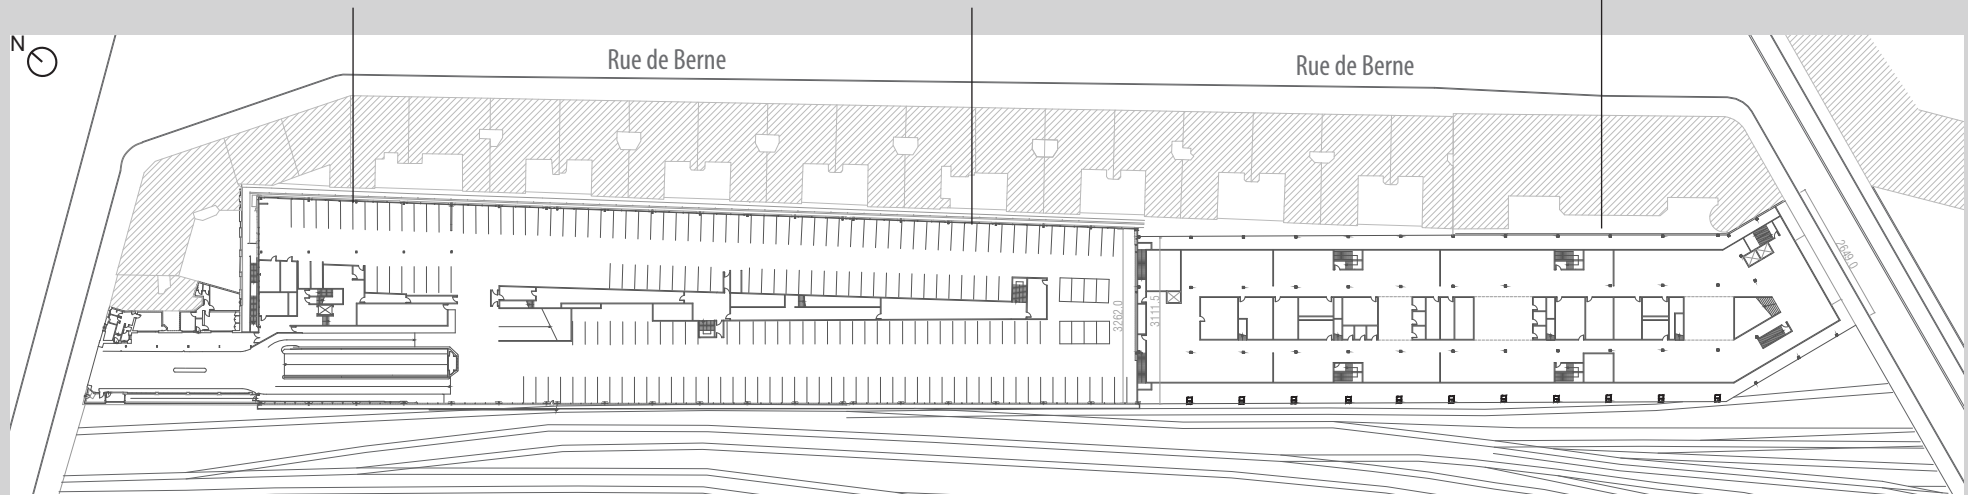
Plan du rez-de-chaussée de la halle des Batignolles et du r+2 de la halle de l'Europe, © document personnel
